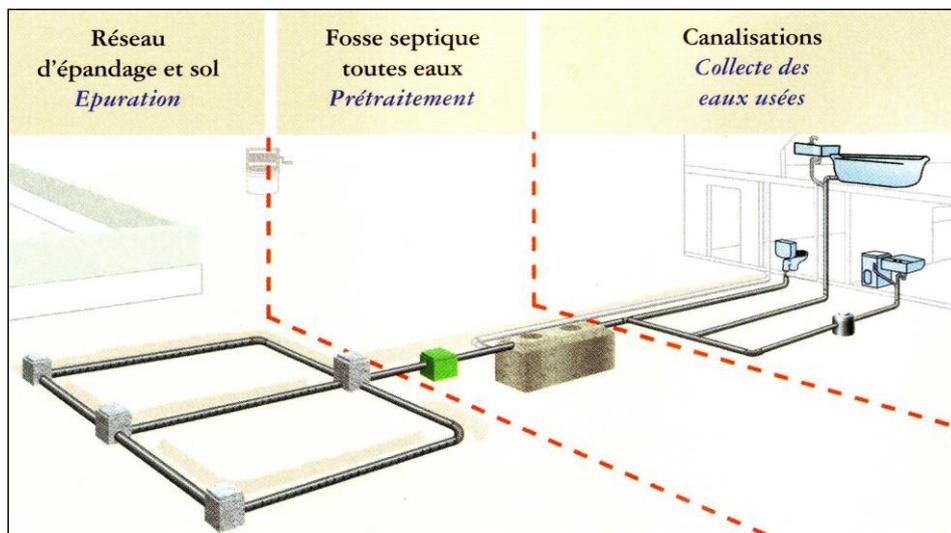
Schéma type d'une installation d'assainissement non collectif¹
